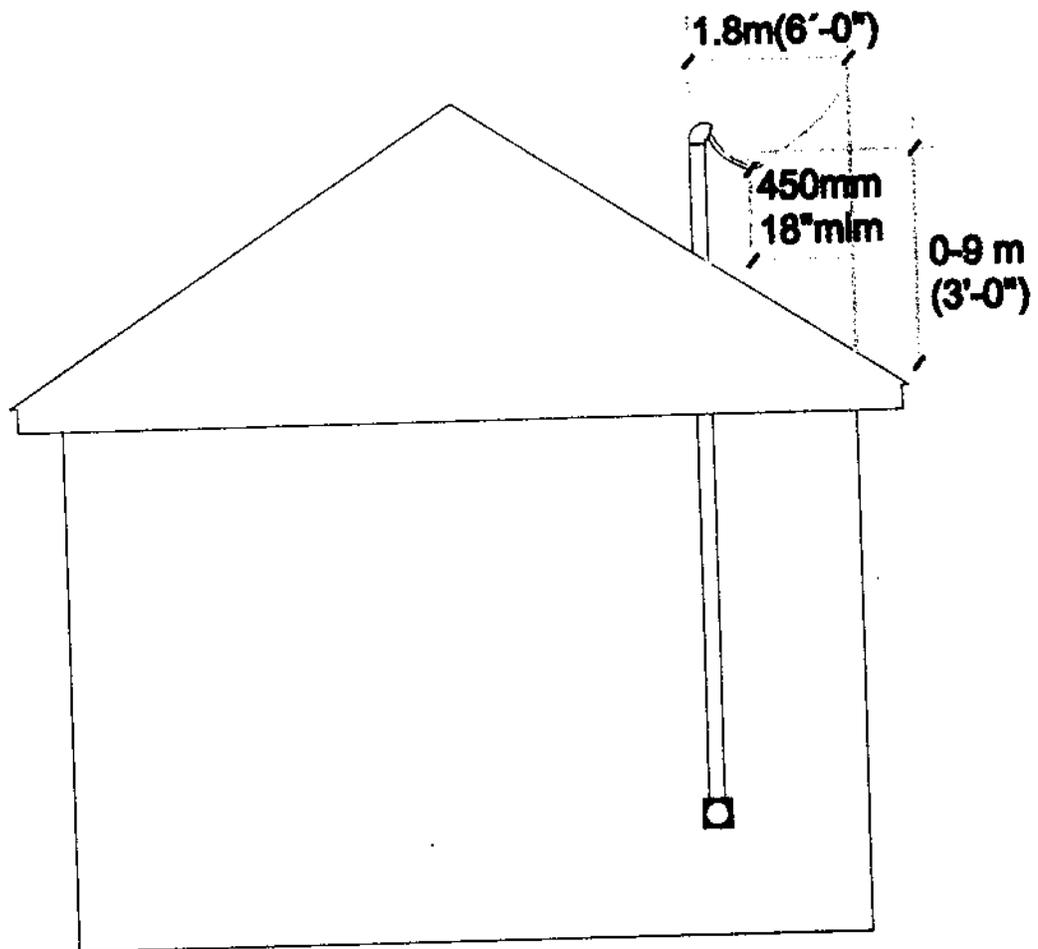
FIG. (C) SEPARACION DEL TECHO DE CABLES DE SERVICIO
